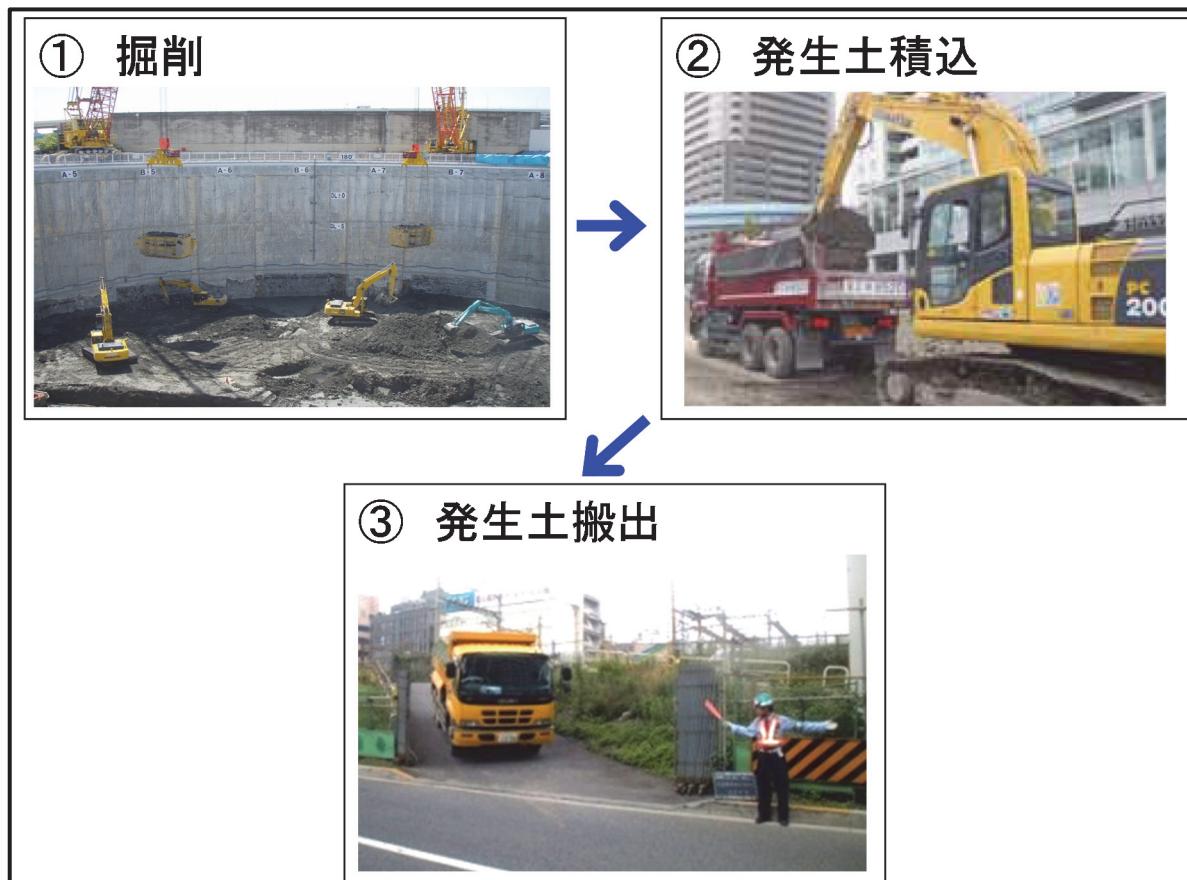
(4) 掘削工の施工手順 (写真は類似工事の例)
